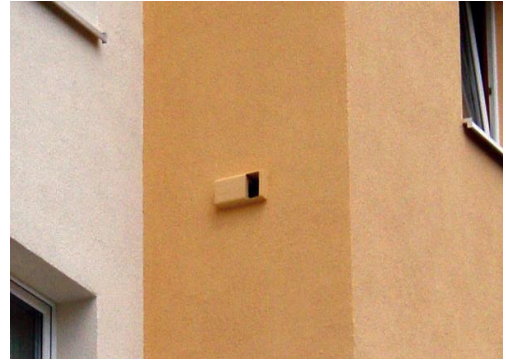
Fassaden-Einbaukasten 1HE, Einbaubeispiel Fassade (Quelle: www.schwegler-natur.de)
